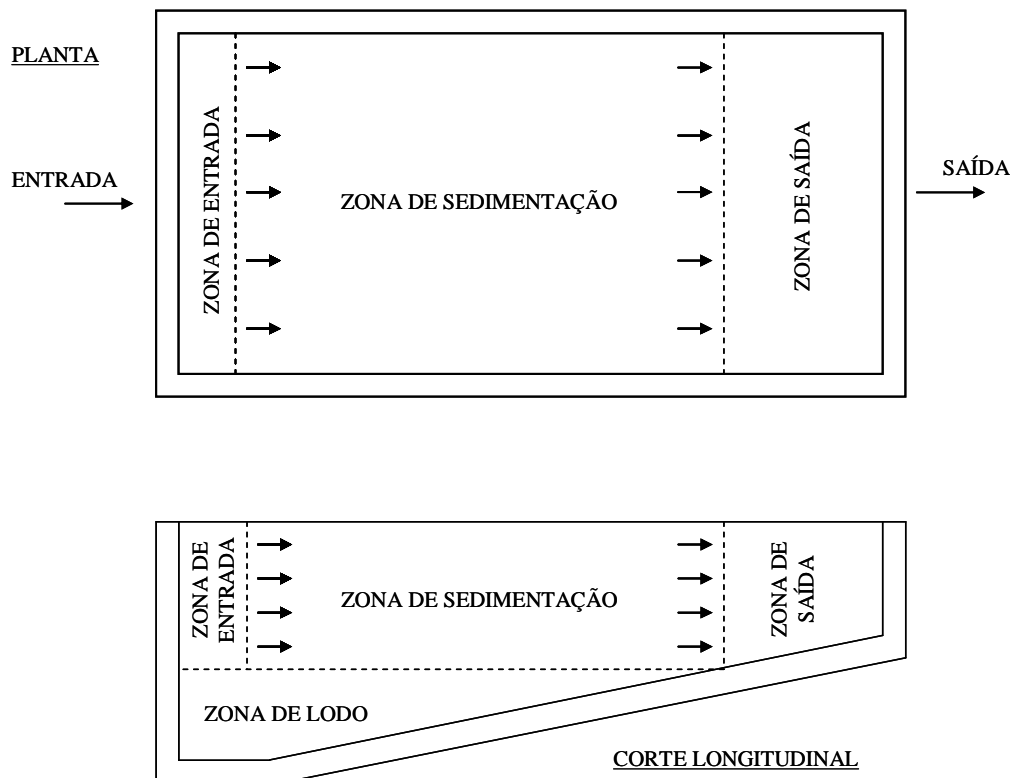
Esquema em planta e corte de um decantador ideal (DI BERNARDO, 1993).
